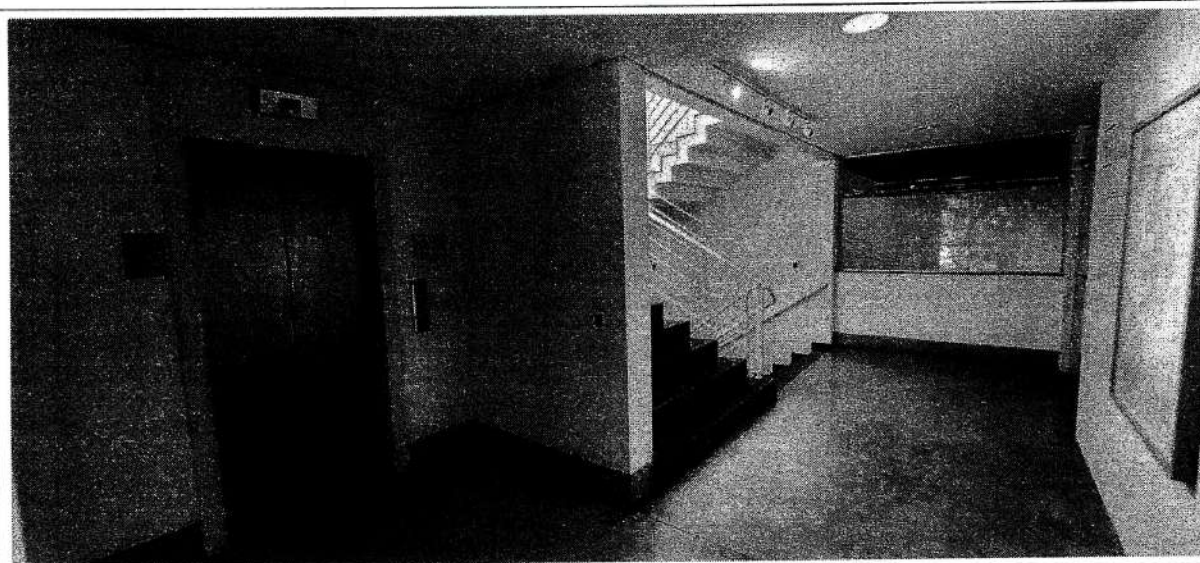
2º pavimento – Elevador sem sinalização tátil de alerta. Escadas com corrimãos em apenas uma altura e sem prolongamento de 30cm, não possui sinalização tátil de alerta e sinalização visual dos degraus, piso em granito sem faixa antiderrapante
